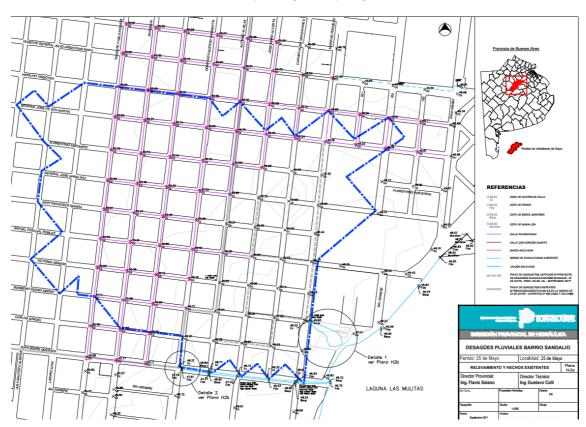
Relevamiento sistema pluvial y cuenca de aporte. Plano H2a
